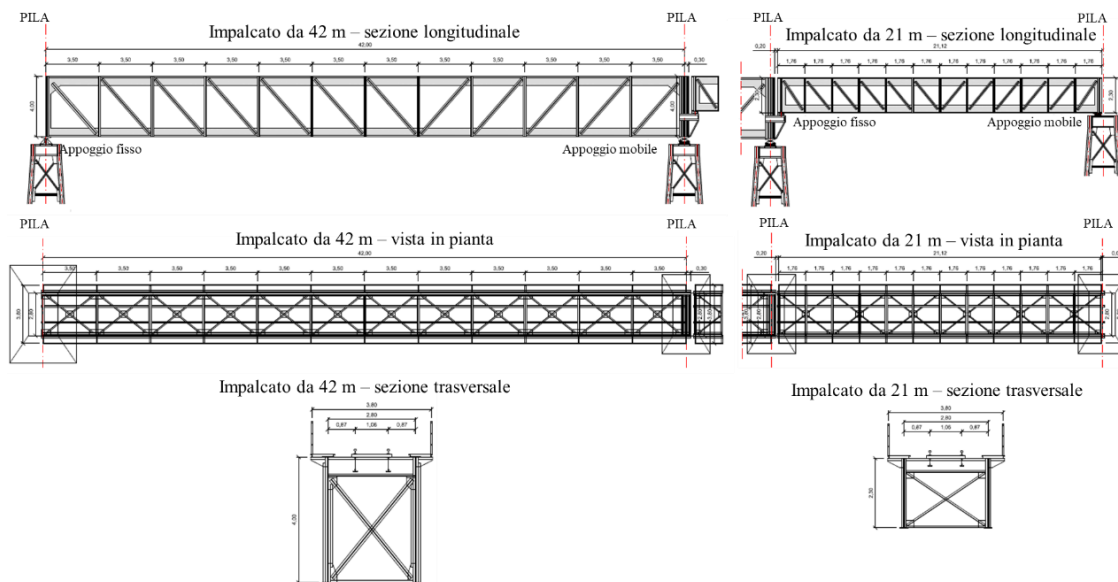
Dall'alto: sezione longitudinale, vista in pianta e sezione trasversale per la campata-tipo iperstatica da 42 m e la campata-tipo isostatica da 21 m.
